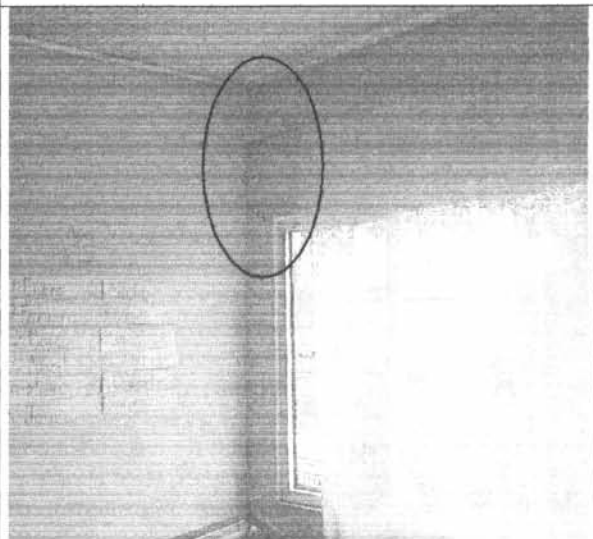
Fisuras en los muros de la sala - Fachada-Piso 3
